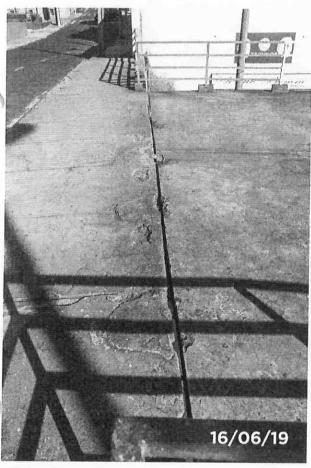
Detalhe da junta de dilatação entre Av. Brasil e a Passarela, apresentando segregação do concreto, trincas, desplacamento do concreto do Passeio.
